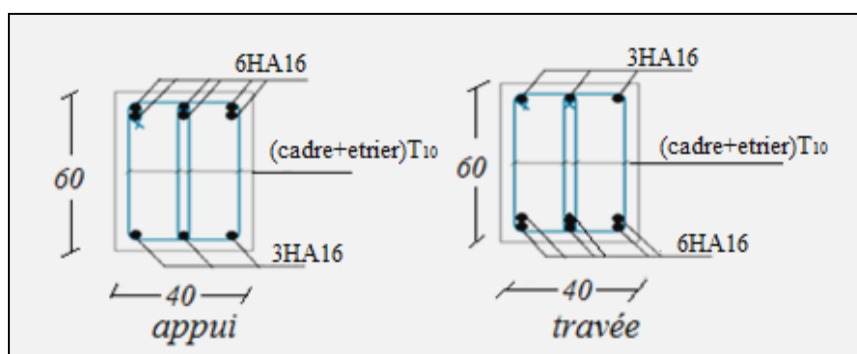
Schéma de ferrillage des poutres principales (terrasse).
